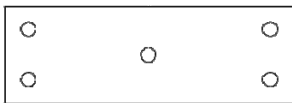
Plans de chevillage des bandes filantes de hauteur h telle que $300\text{ mm} < h \leq 400\text{ mm}$ (le nombre de chevilles par m² est donné pour $h = 400\text{ mm}$)
